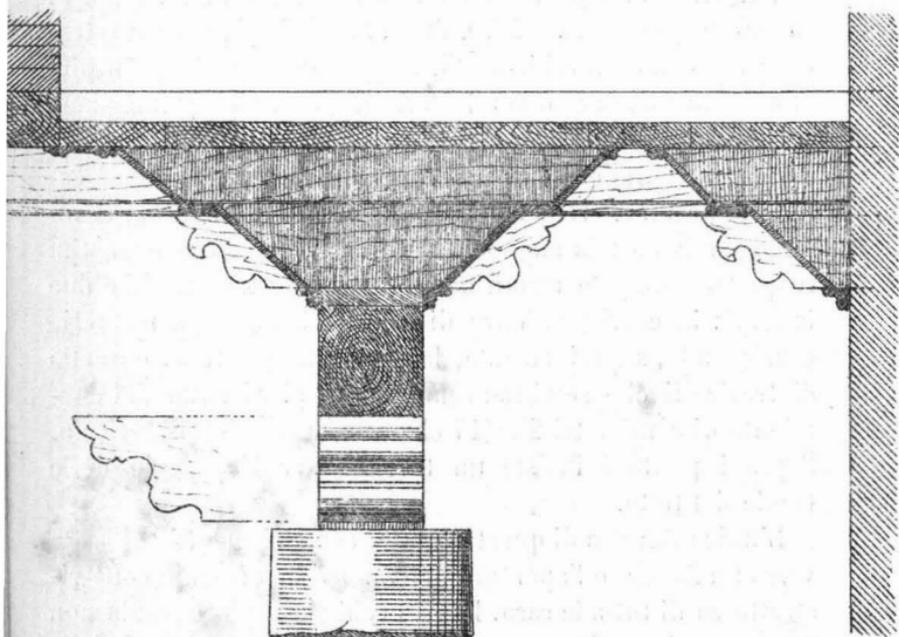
Sezione trasversale d'un soffitto (1 a 25).
